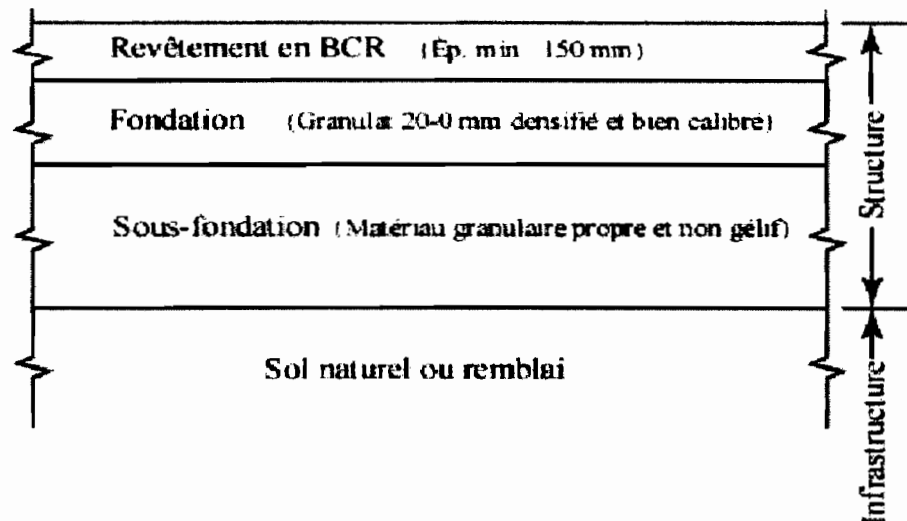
Schéma-type d'une chaussée en BCR [1]
